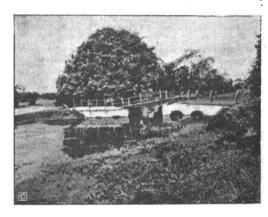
Ponte sopra un canale a Ragpur dopo il terremoto di Assam dei 1877. Travata sollevata su una spalla (Da Oldham).
